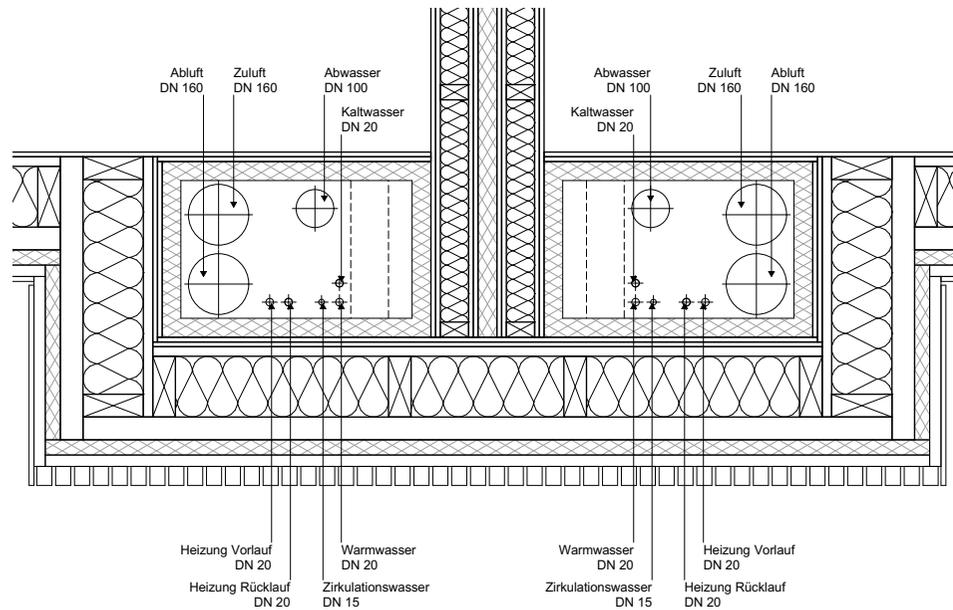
Detail Haustechnik Grundriss M 1:20
